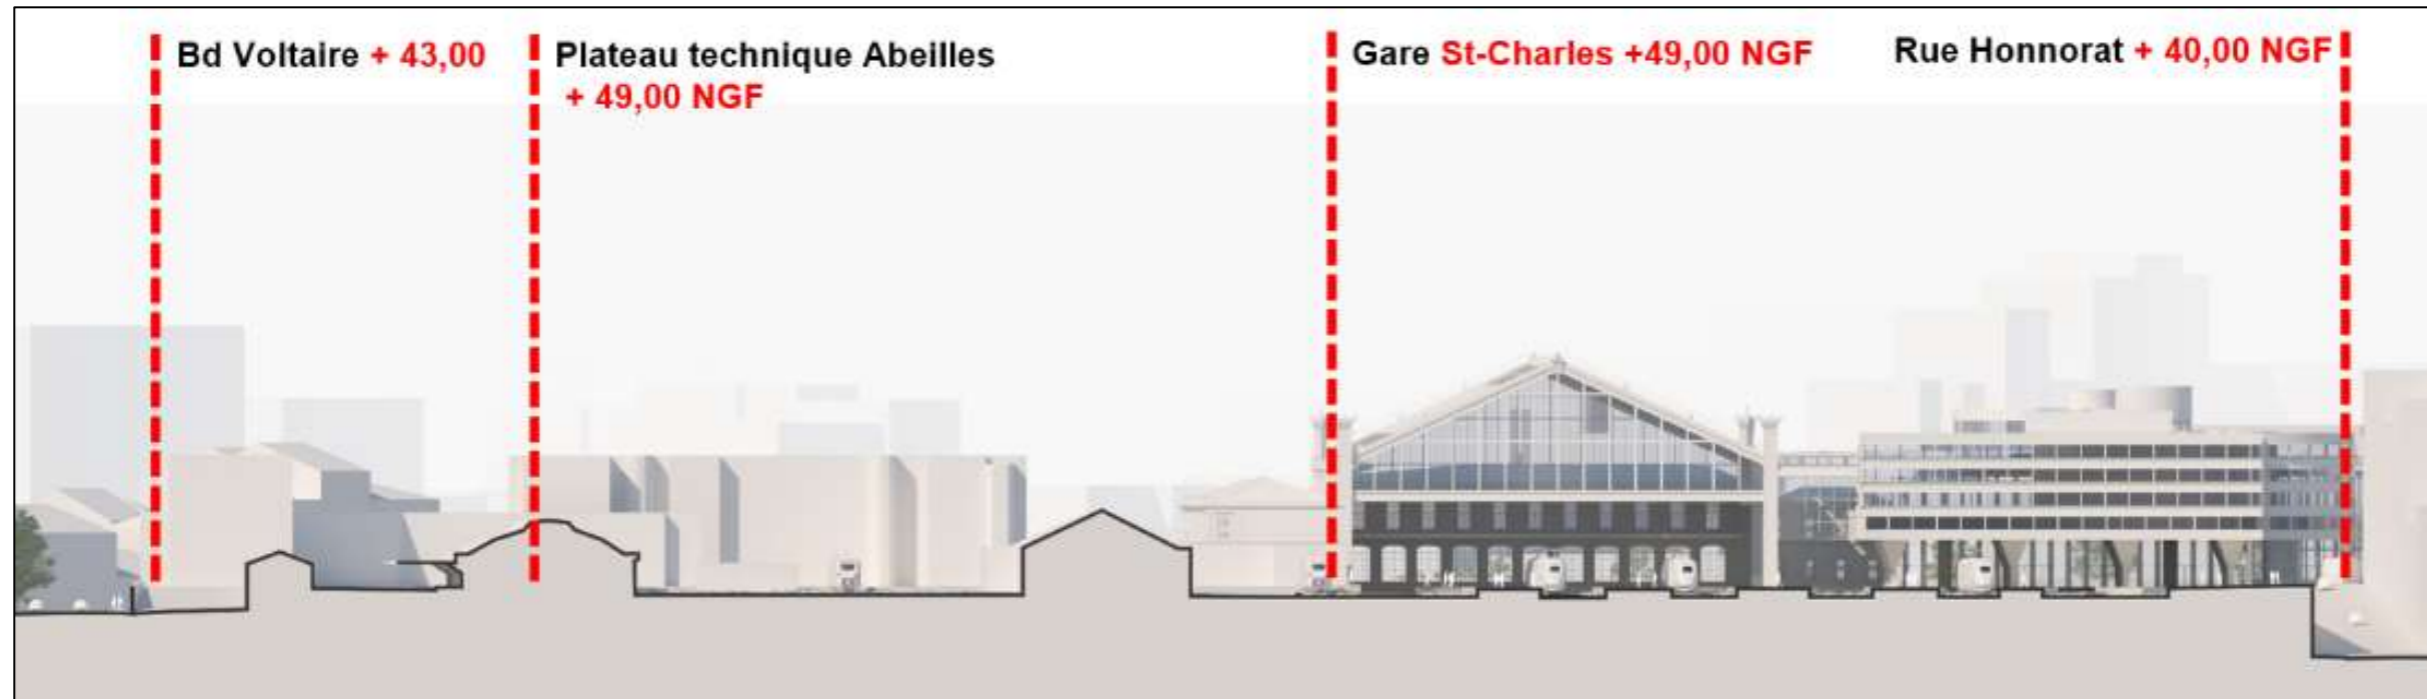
coupe transversale sur le plateau ferroviaire - existant/projet - illustration de la réalisation d'un accès de plain-pied à la gare
